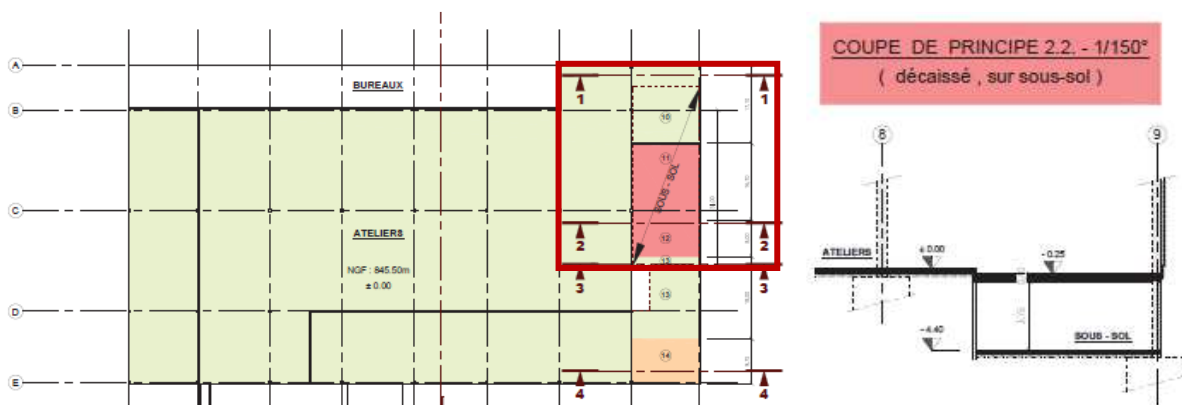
PLAN DE LOCALISATION R-1 EN SOUS-SOL
